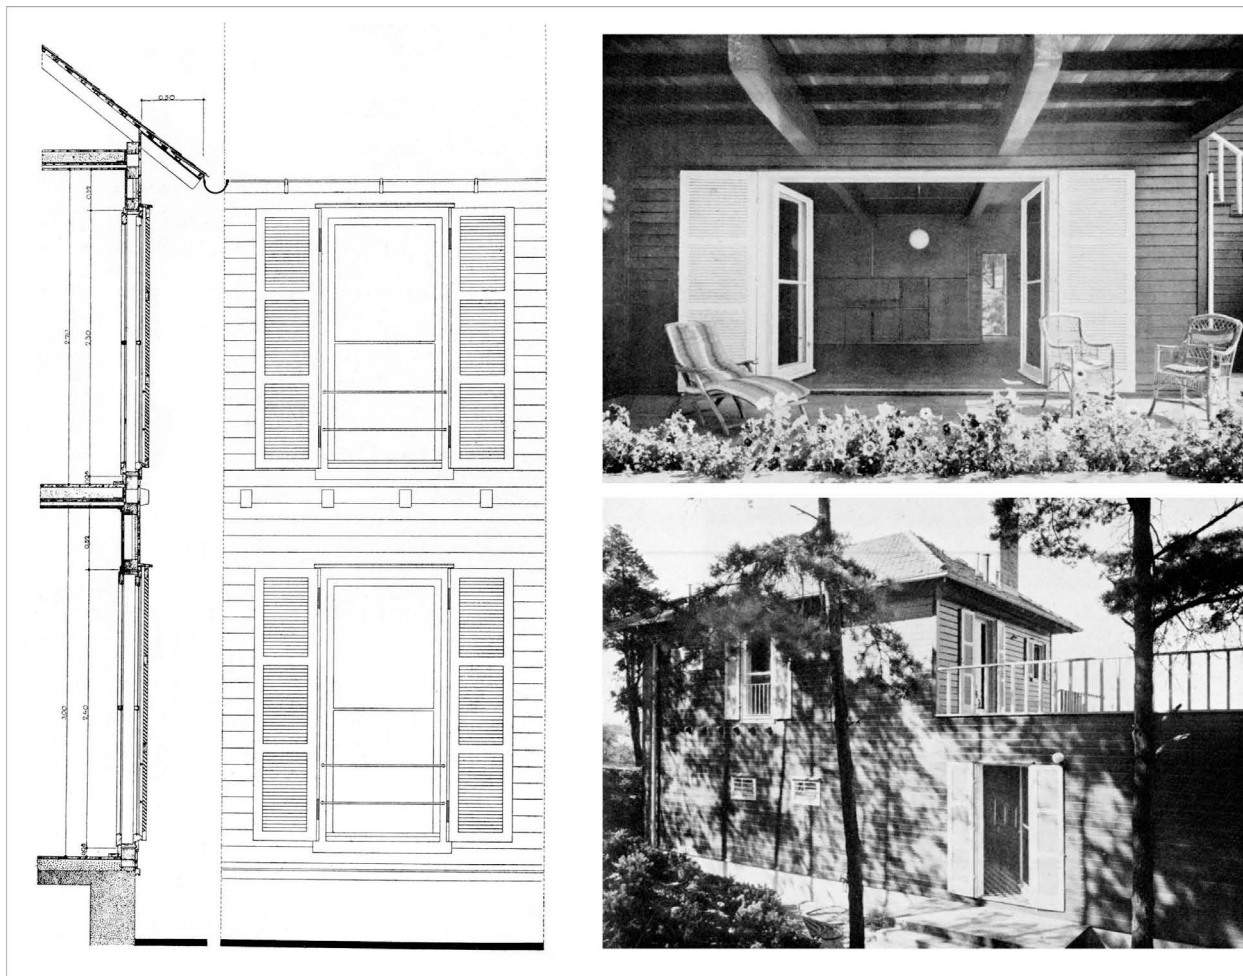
Casa para Einstein. Sección constructiva e imágenes de fachada. K. Wachsmann. (Wachsmann, 1930).
